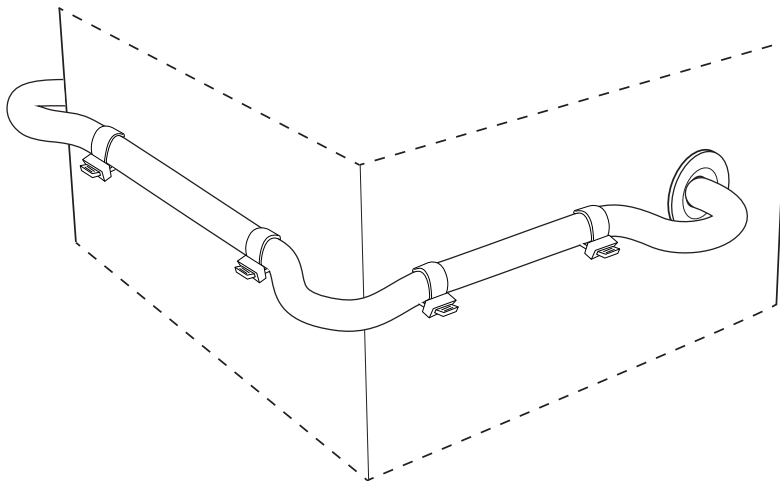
Das Kabel vor scharfen Kanten schützen und Kabeldurchführungen verwenden
